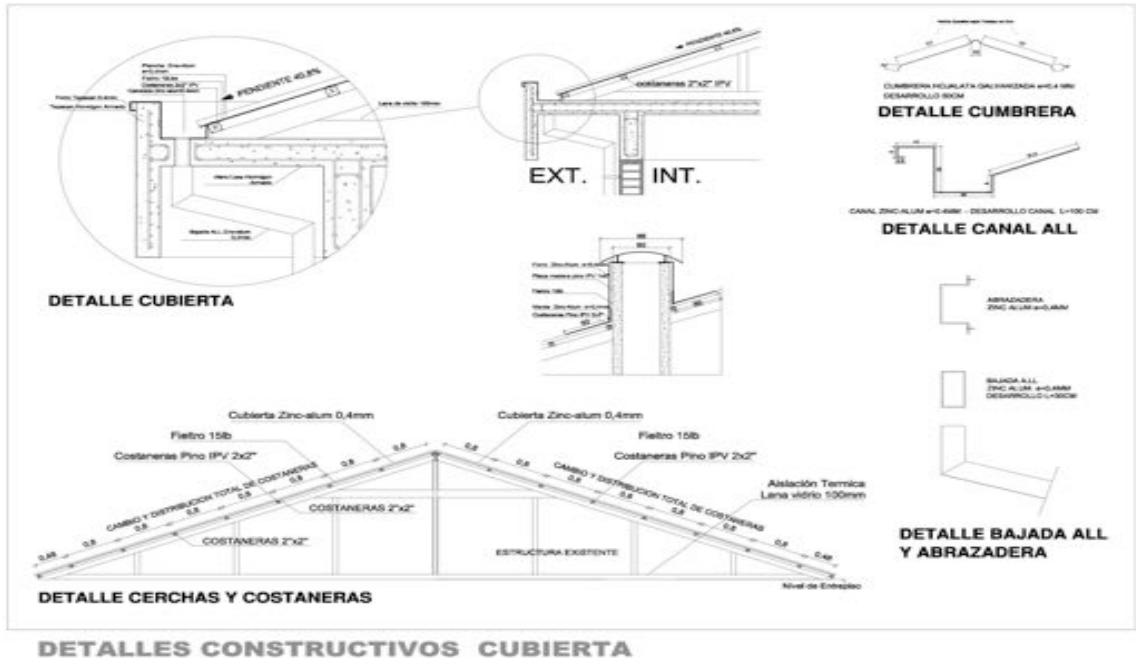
Detalles de cubierta y Alero Block 1010 Fuente: elaboración propia.
